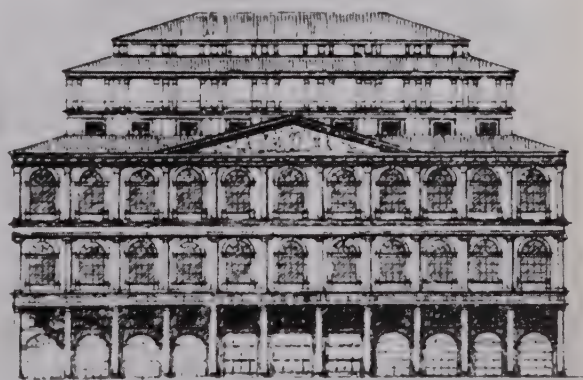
Progetto di teatro per Novara (1857). I diaframmi murari si articolano indipendentemente dalle strutture portanti. Concezione unitaria e organica in un tipo di edificio che l'Ottocento concepì come giustapposizione incoerente dell'auditorio al blocco scenico, mascherata con eccessi decorativi alla Garnier
